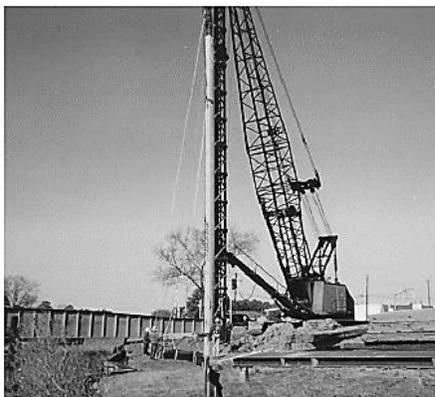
Proceso Constructivo de Cimentaciones Preexcavadas
